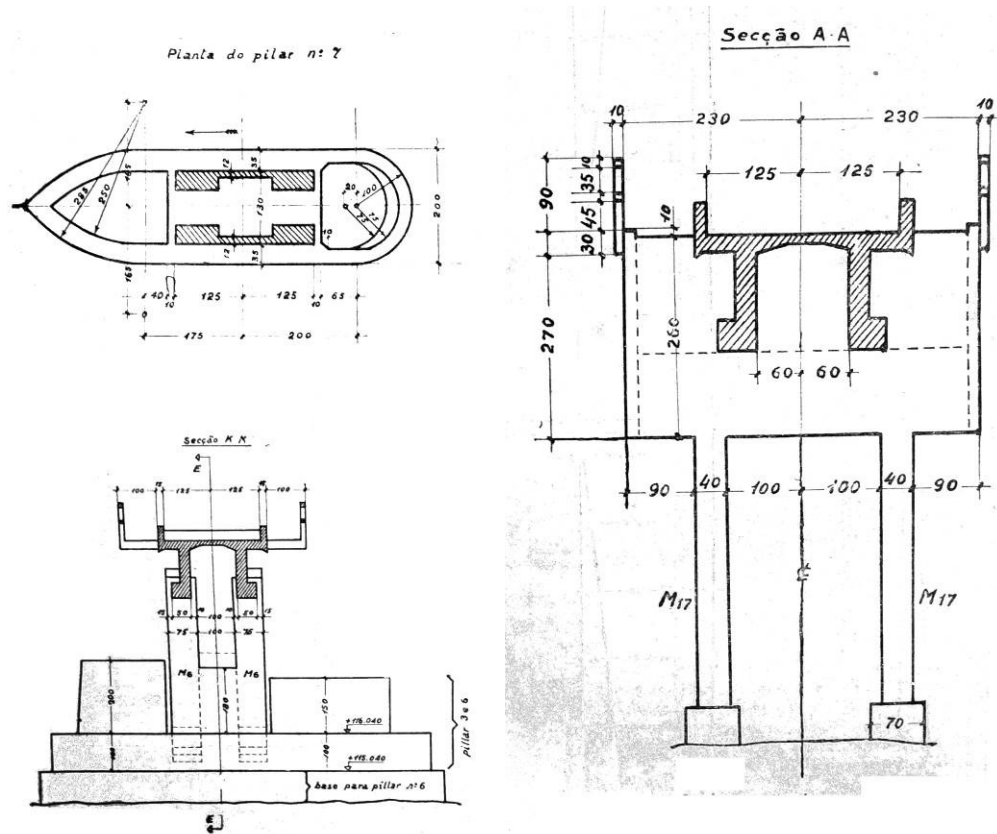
Esq. Planta mostrando o detalhe de um dos pilares e seção transversal da ponte nos vãos laterais. Dir. Seção transversal da ponte. FONTE: CONCRETO, 1939.
